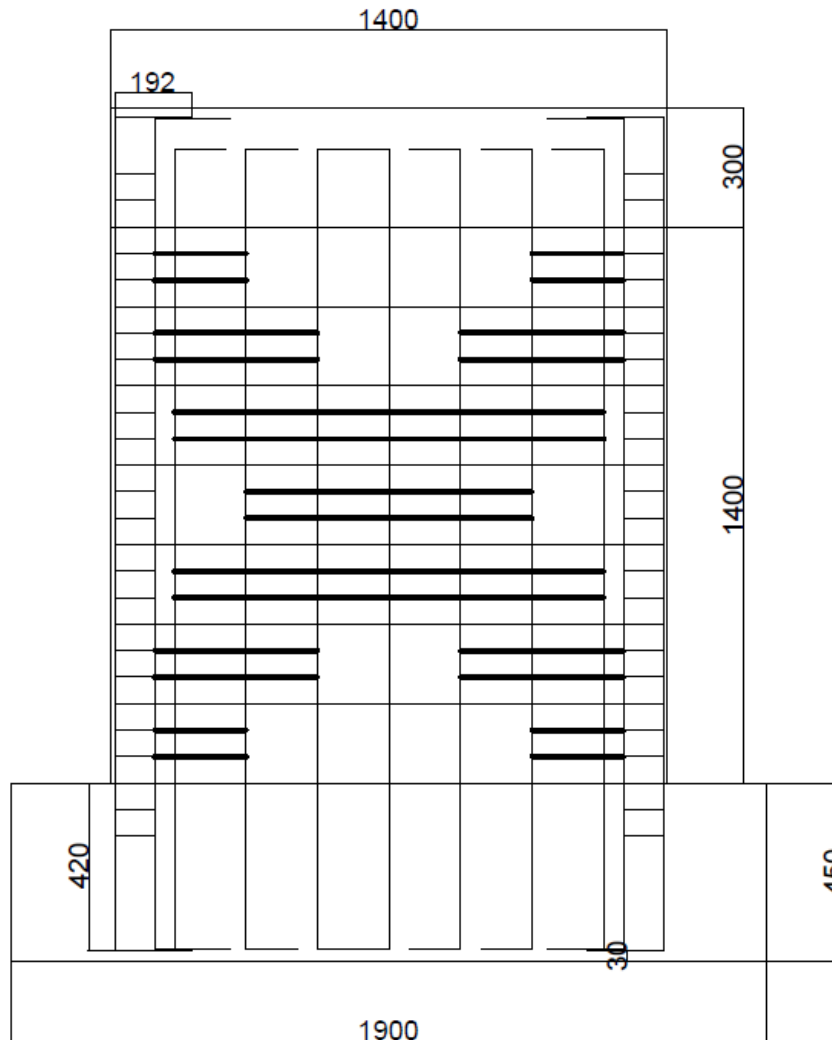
Disposición de estribos en el alma del muro alternativo.
